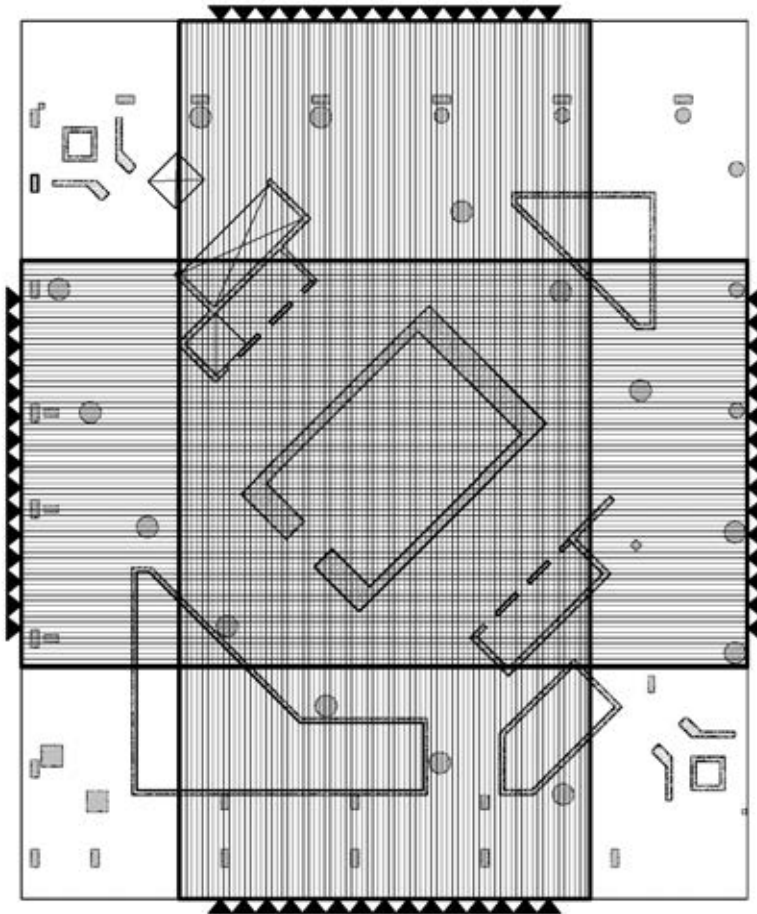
Esquema con la distribución de cables de pretensado en la losa de cimentación.
